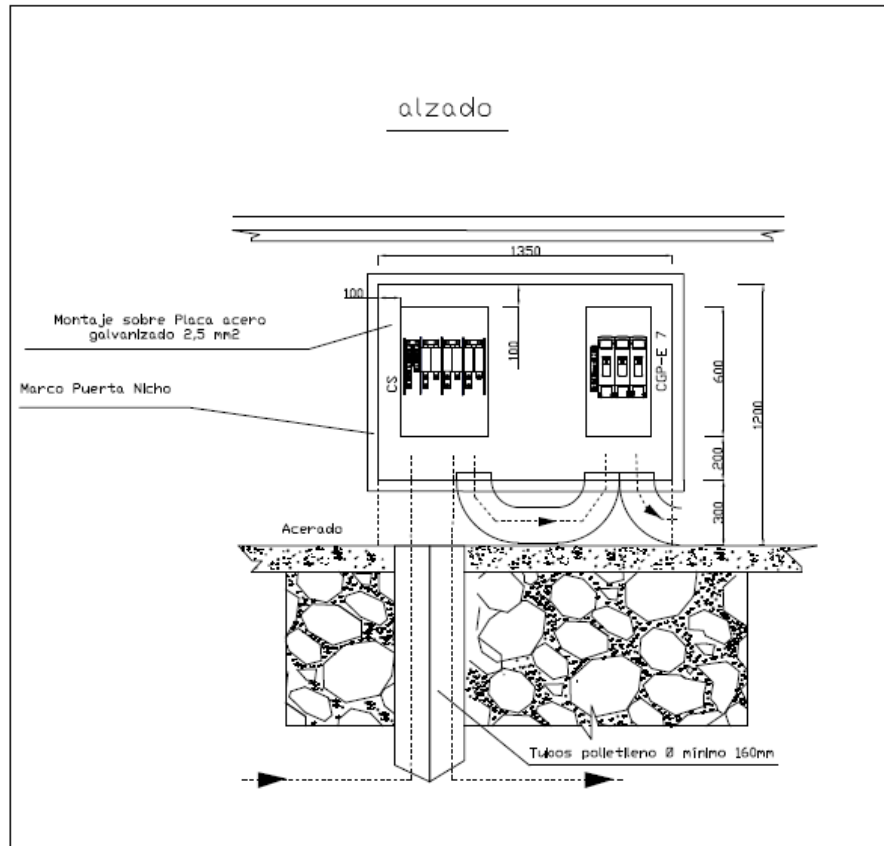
Instalación CGP y CS montaje horizontal. Alzado.
